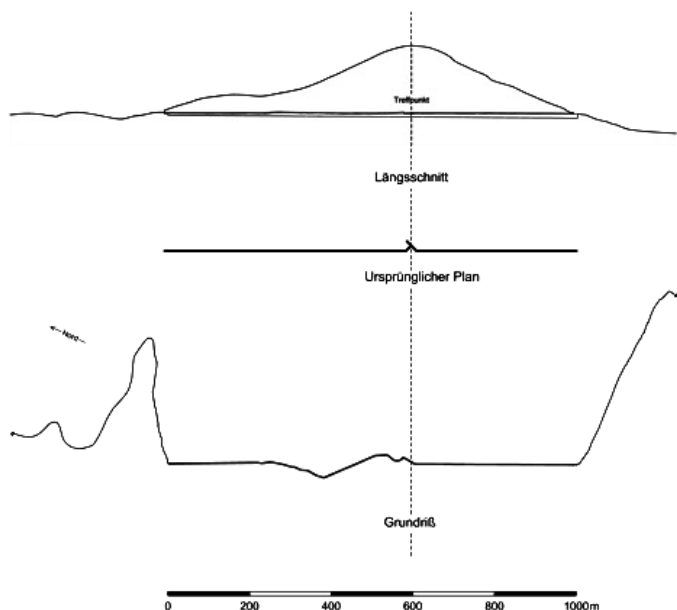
Längsschnitt durch den Berg mit dem ursprünglichen Planungsgrundriss und dem tatsächlich ausgeführten Tunnel.
